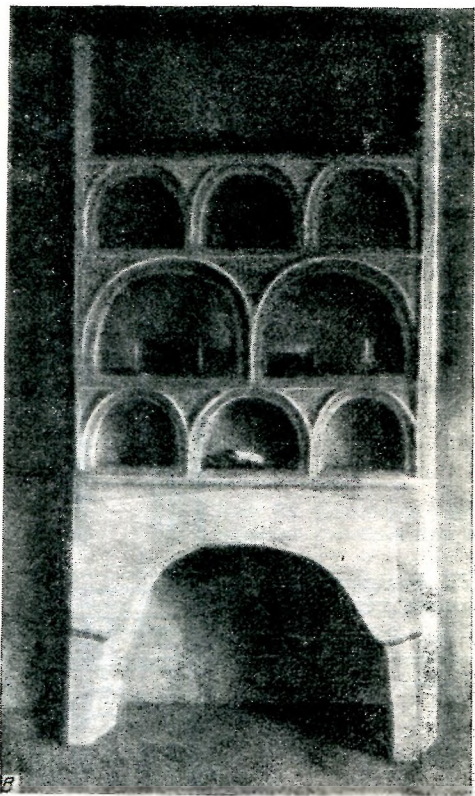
Глиняный орнамент на фасаде, балконе и внутри помещения
